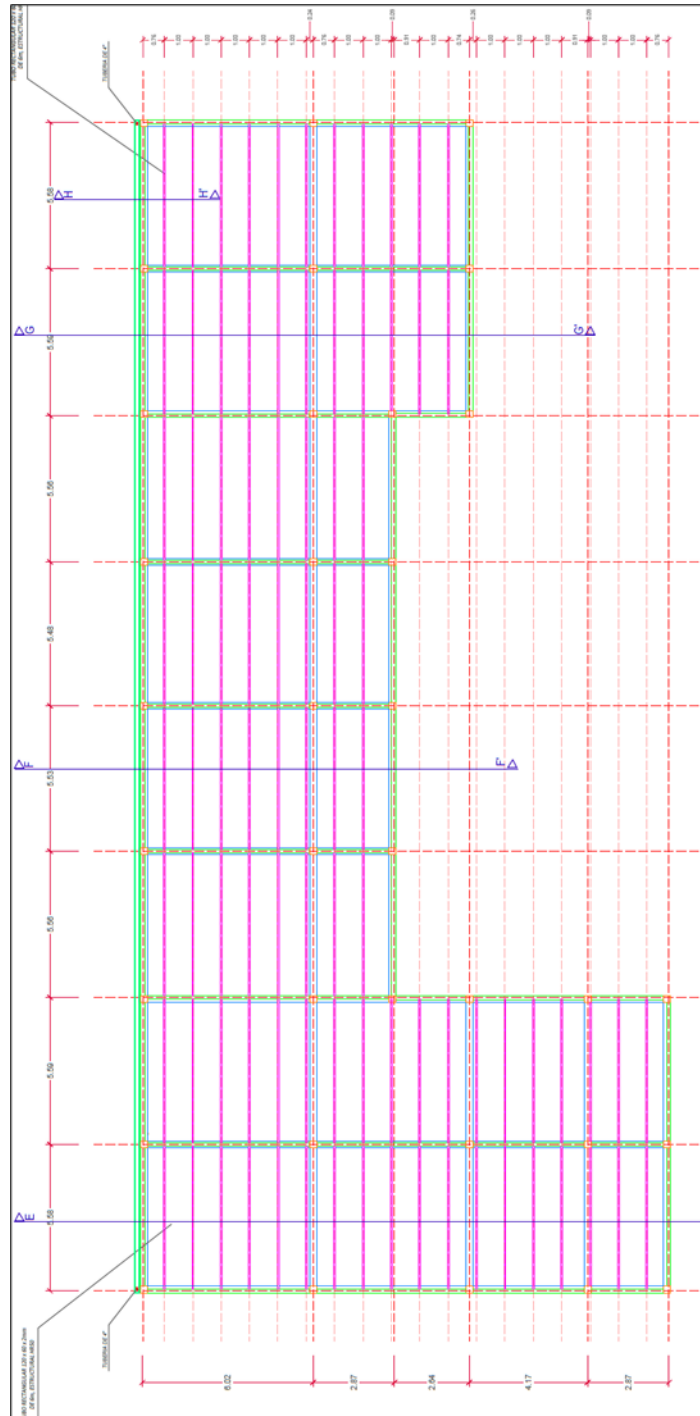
Vista en planta de entramado de perfil de acero de la estructura 2 del Centro Vida.
